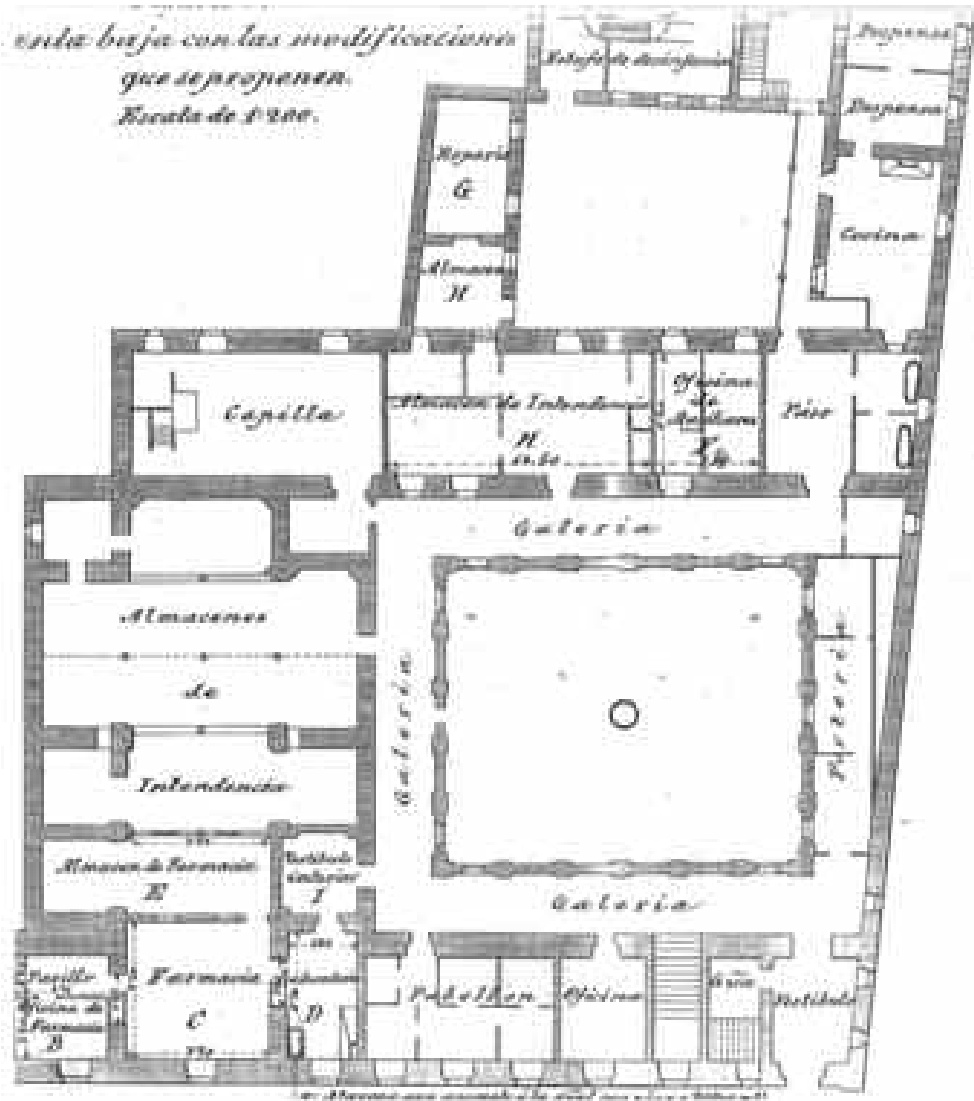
Planta baja H. militar. 1918. La farmacia se traslada. A.G.M.A.
